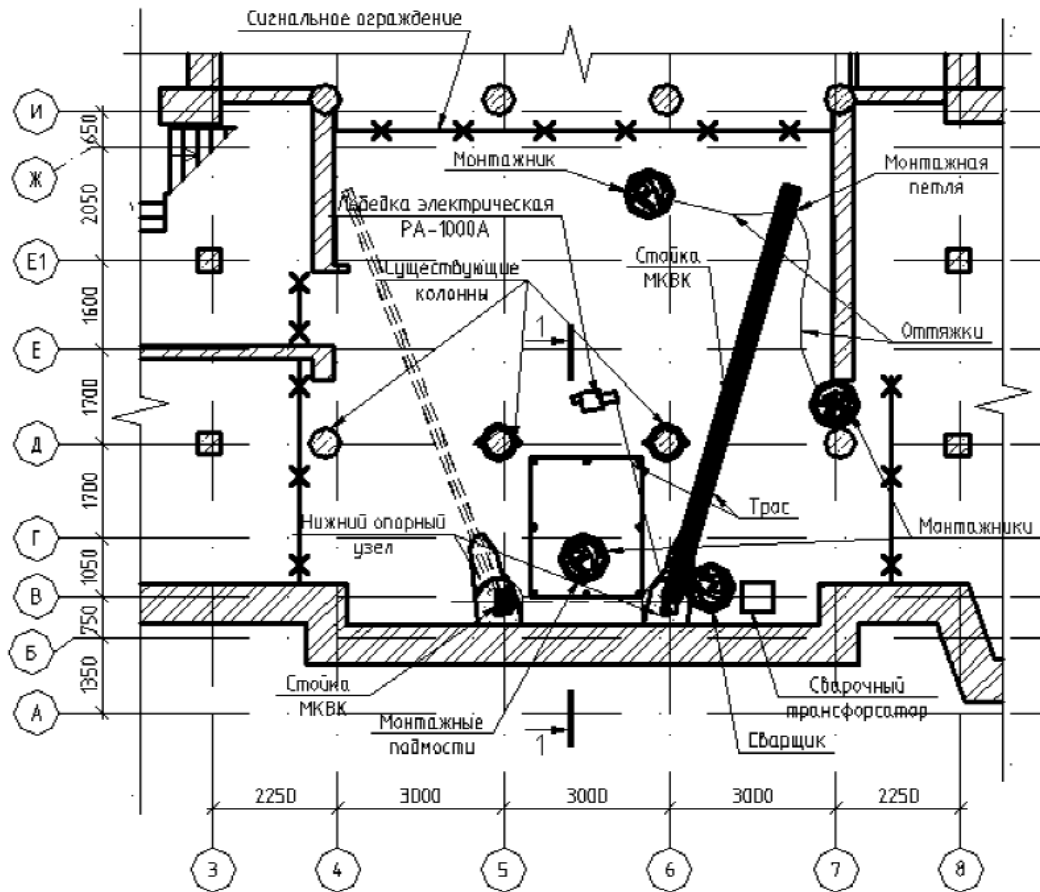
Схема выполнения работ по устройству металлической конструкции временного крепления (МКВК) междуэтажного монолитного перекрытия на период замены участка кирпичной стены
